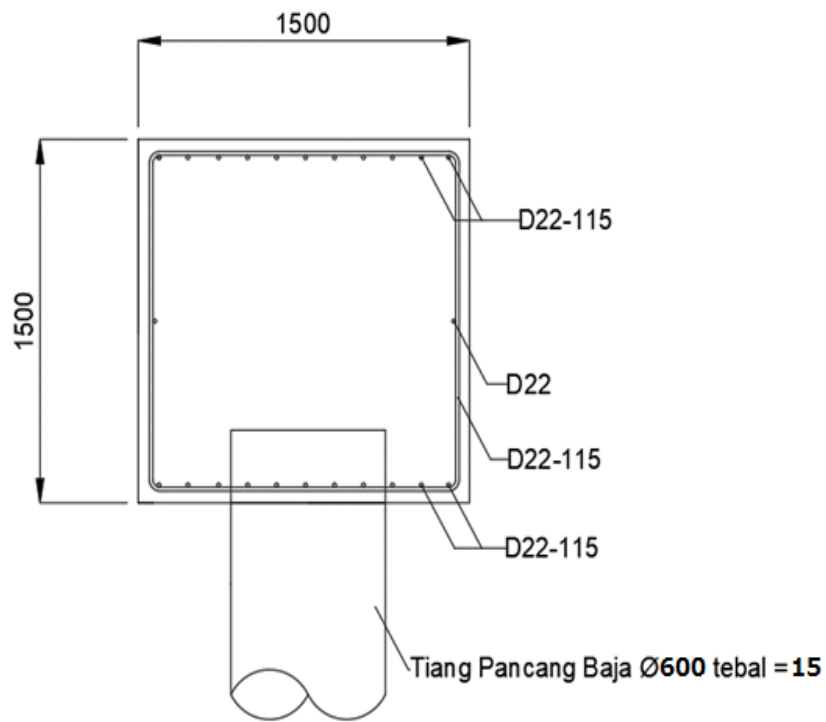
Detail Desain Tulangan *Pile Cap Crane* Potongan Melintang
